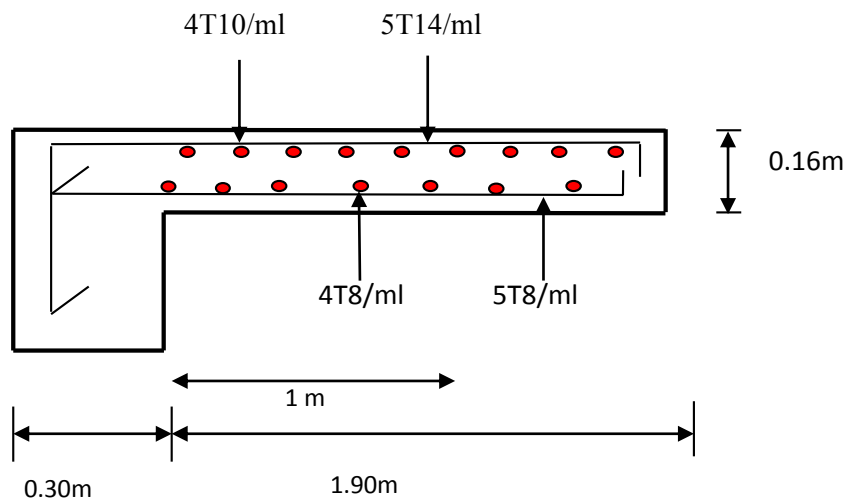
Ferrailage du balcon encastré sur trois côtés.
